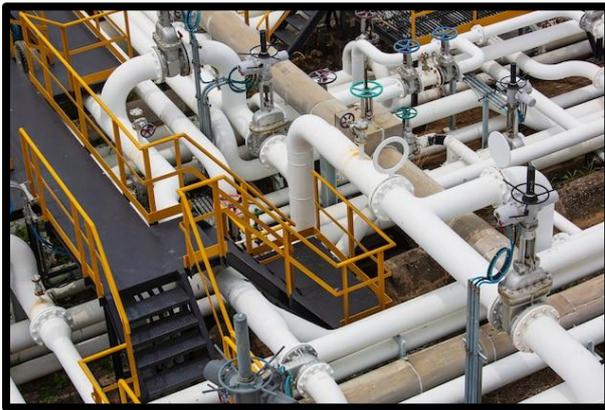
tuberías en posición final en referencia a indicado en plano. Fuente: la empresa.
